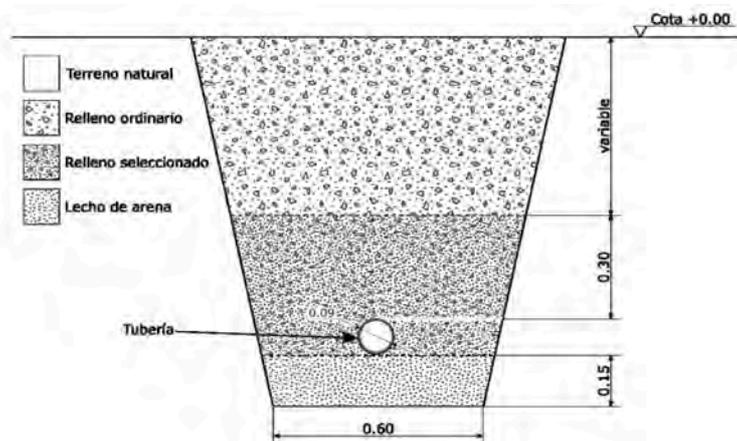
Esquema constructivo de las zanjas en las que se alojarán la red de conducciones.
